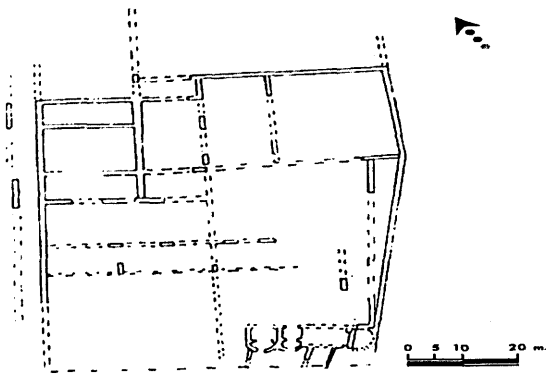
Giba. San Pietro di Tului: planimetria (da ZUCCA 1987b).
